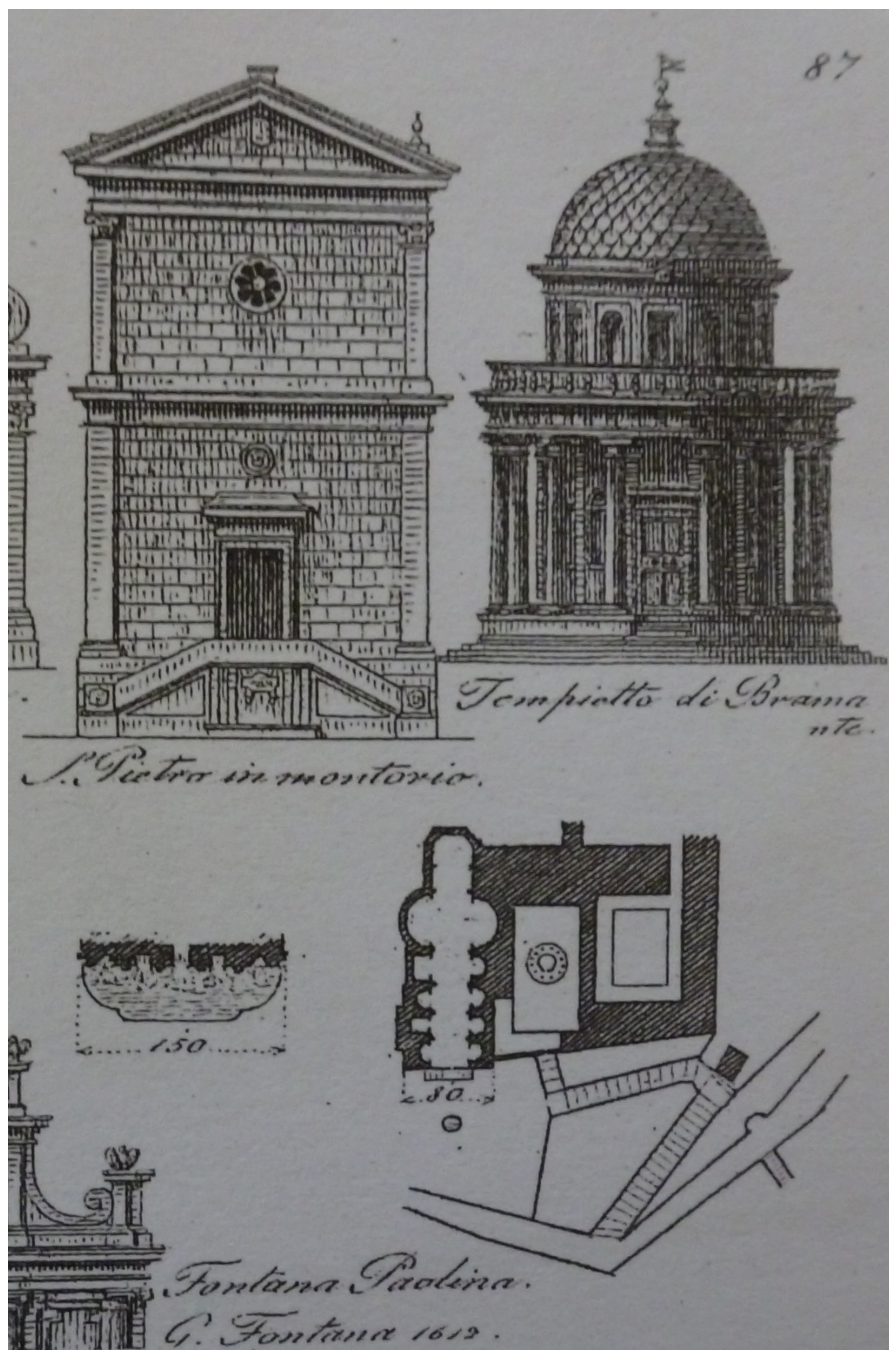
G.B. Cipriani, prospetto e pianta del complesso di San Pietro in Montorio, 1835, tav .87
